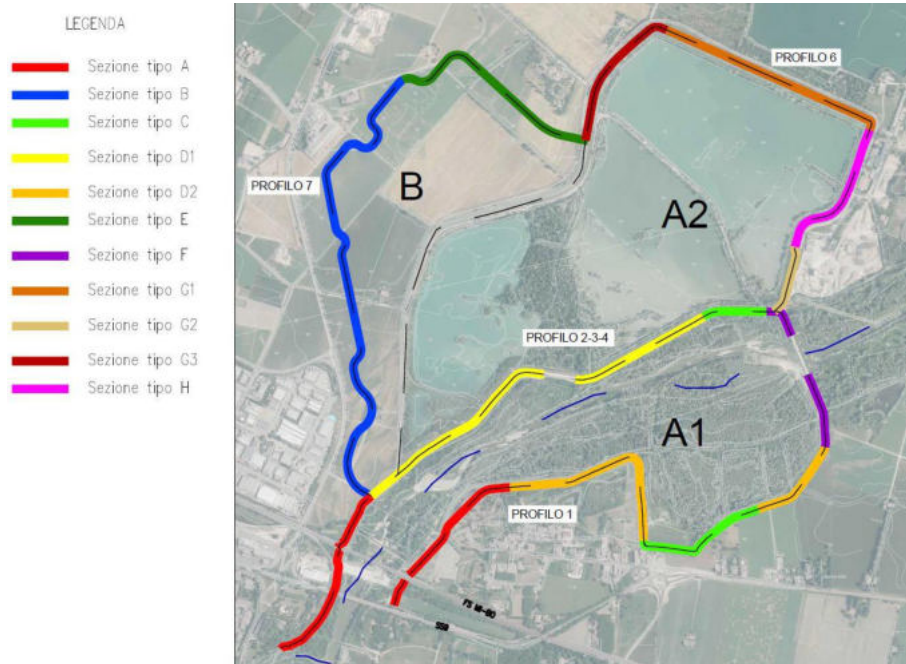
Planimetria degli interventi con indicazione delle tipologie di sezioni
